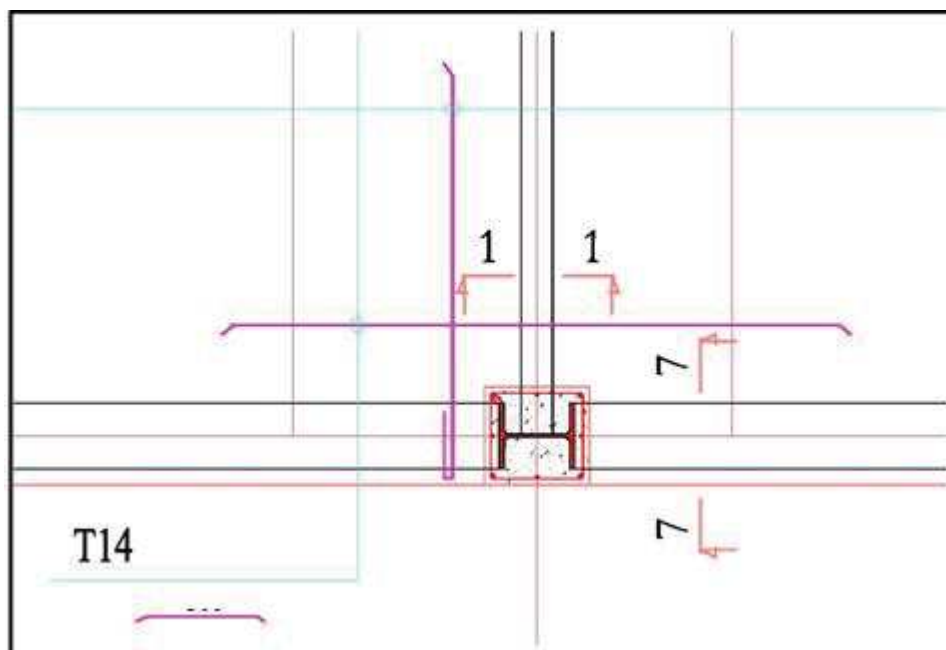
ferrailage de la dalle avec armatures en T14
